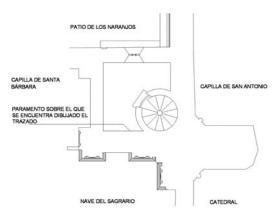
Planta del habitáculo donde se encuentra el trazado arquitectónico
